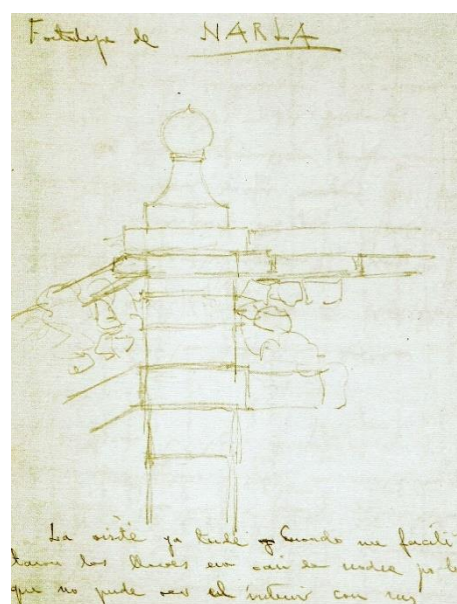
Detalle del muro de la rampa de acceso rematada con pilastra, pináculo y albardilla. Ídem, p. 314.
